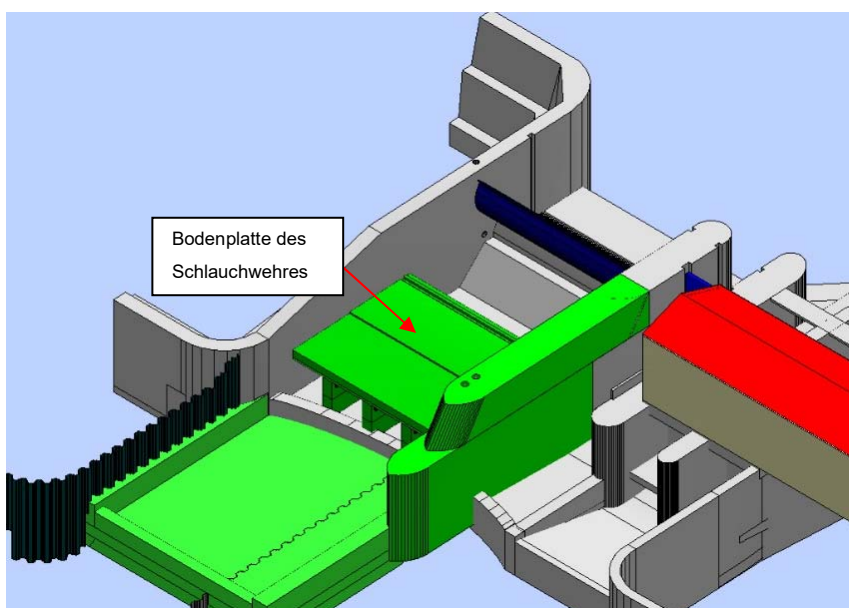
Bodenplatte für das Schlauchwehr auf Fertigteilen aufgelagert
